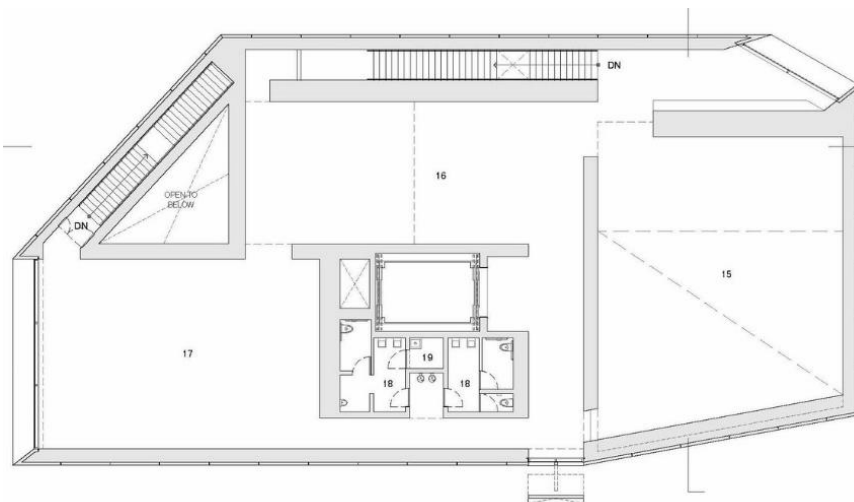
Planta arquitectónica de planta baja del Centro de Arte Contemporáneo Ruby City. Pintos, P. (15 de octubre de 2020). ArchDaily.
